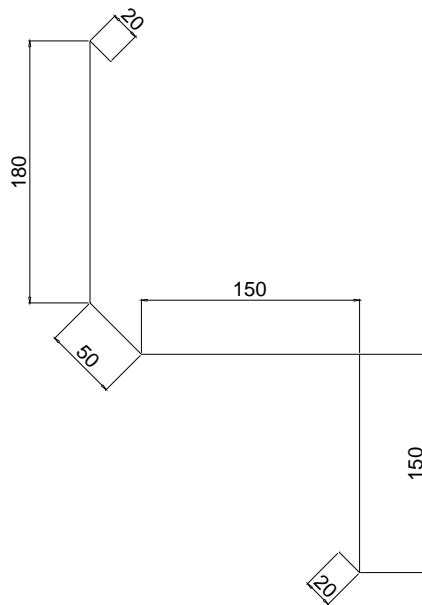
Raccord sur embase de lanterneau ou désenfumage (épaisseur 1 mm)
